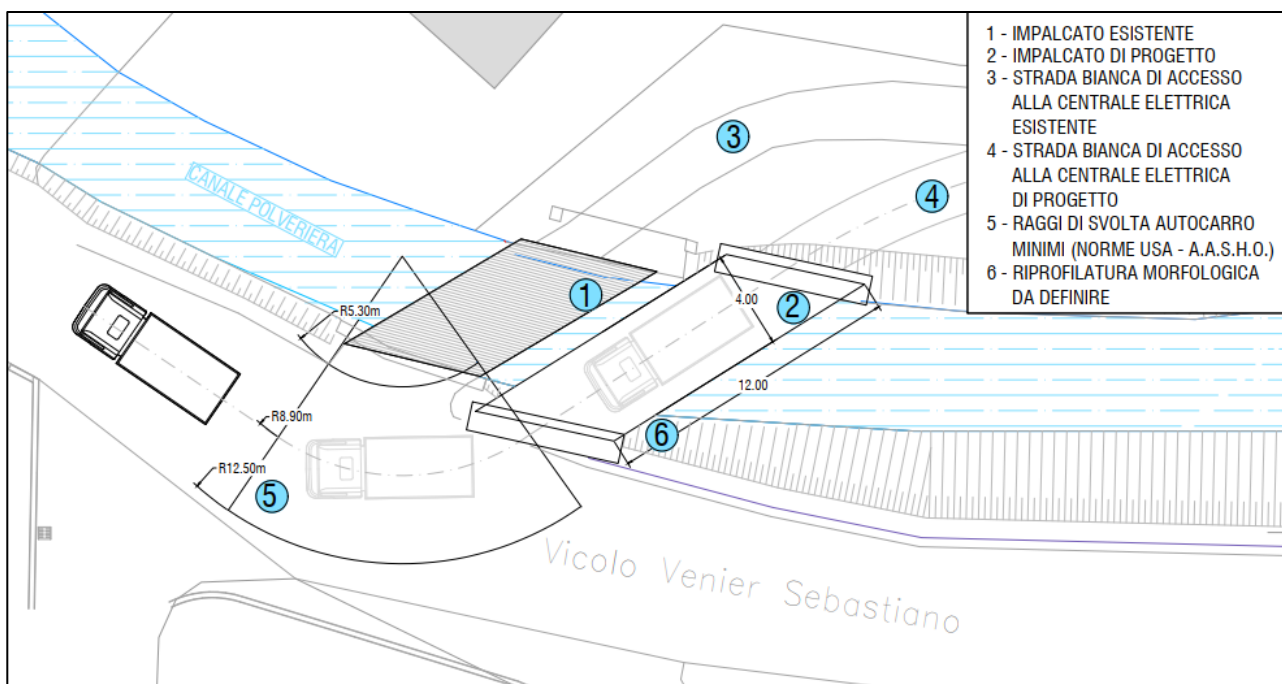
Planimetria stato di progetto ponte di accesso area SIED
